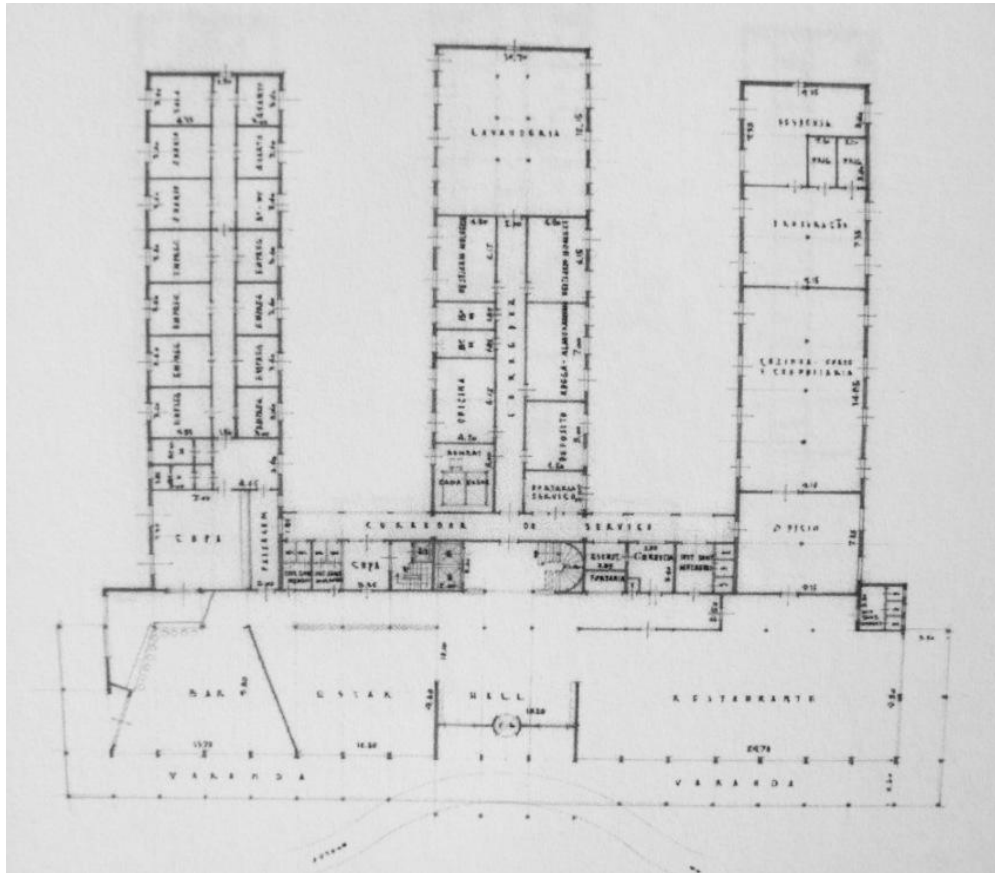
Sexta proposta: planta do 1º e 2º andar.
